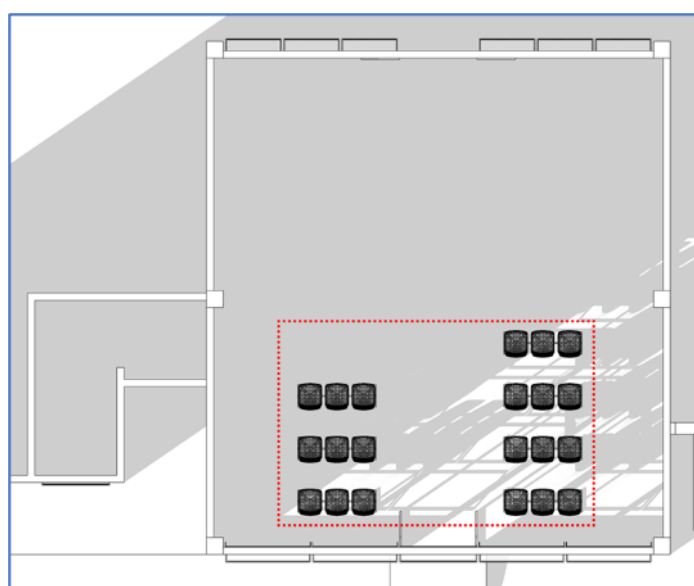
Planta baixa da recepção com delimitação da zona de interesse
